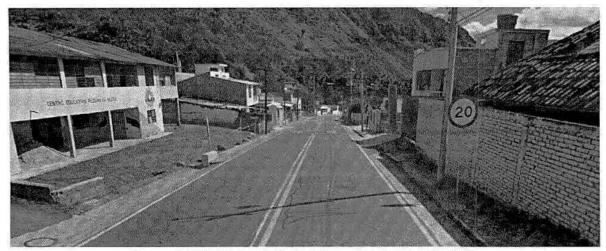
Caja de alcantarilla tapada margen derecho año 2014.
